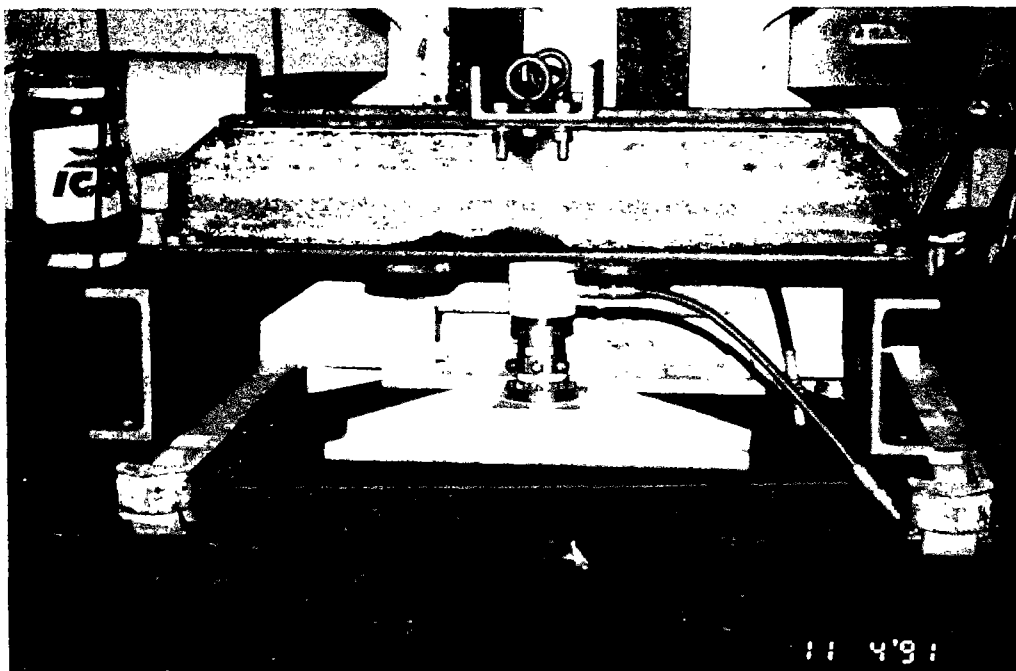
Dispositif de chargement : vérin hydraulique et semelle de fondation
